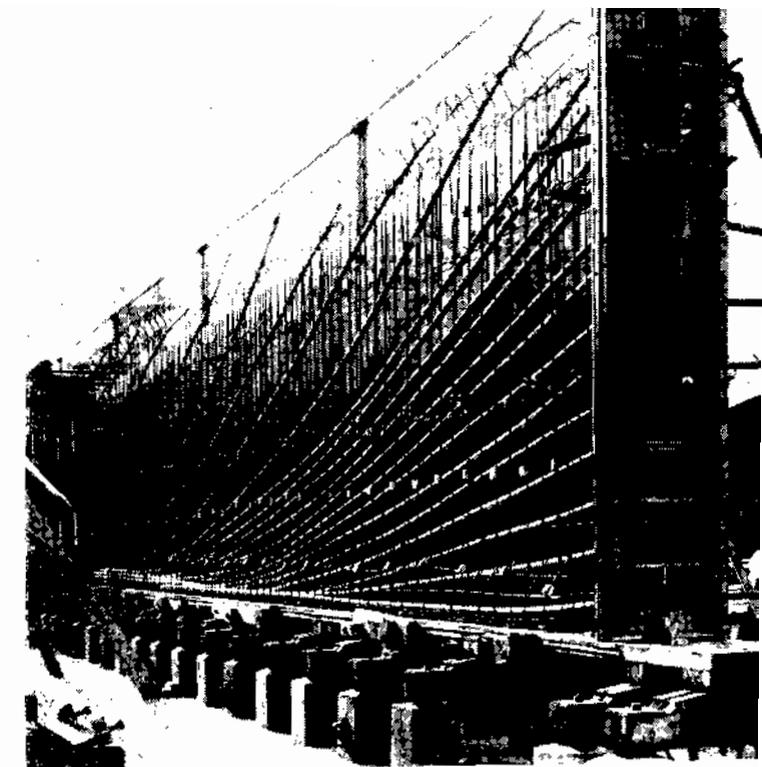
Puente sobre el canal Amstel.- Amsterdam.- Holanda.
